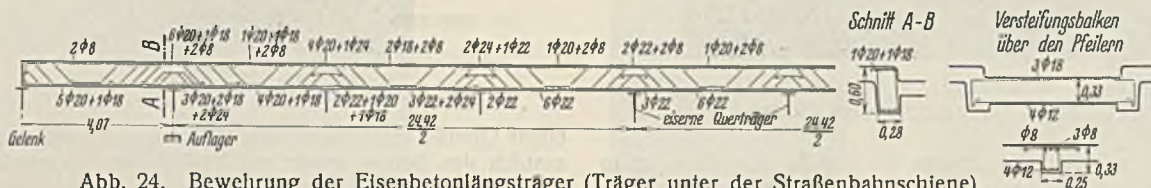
Bewehrung der Eisenbetonlängsträger (Träger unter der Straßenbahnschiene).
